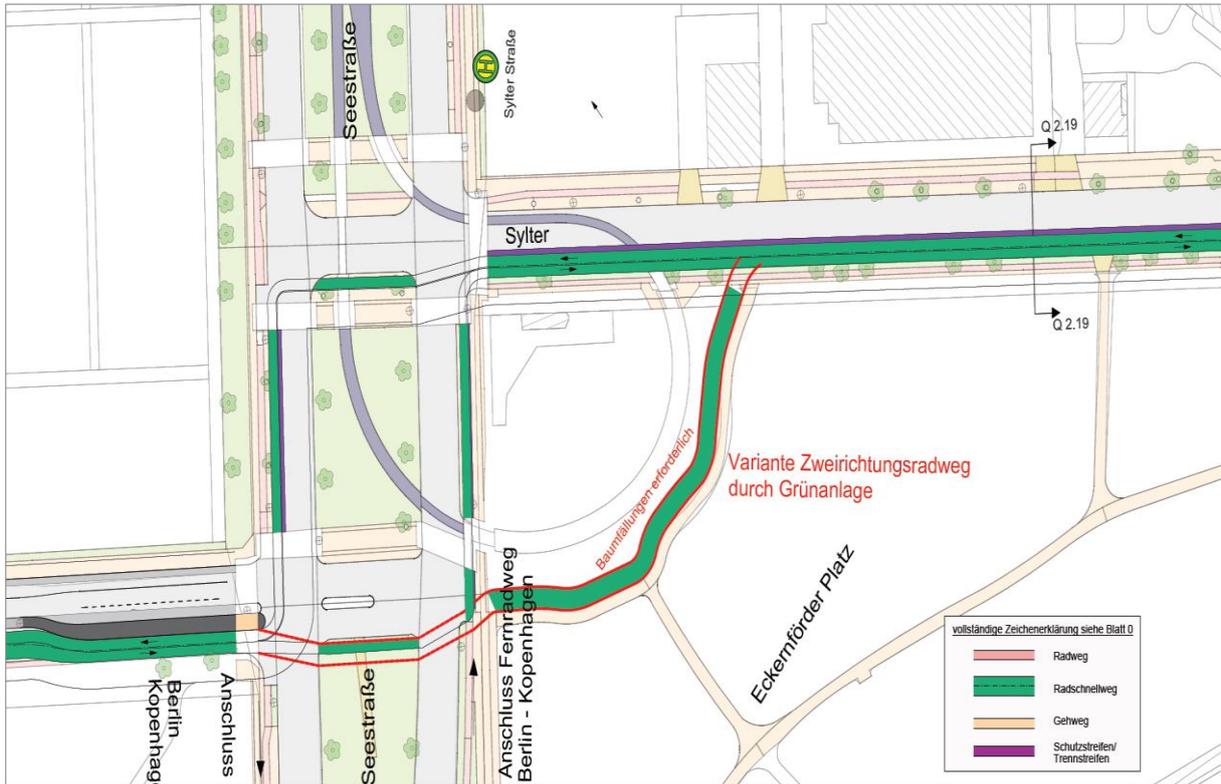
Knotenpunkt Dohnagestell/Seestraße/Sylter Straße mit alternativen Trassenführungen
